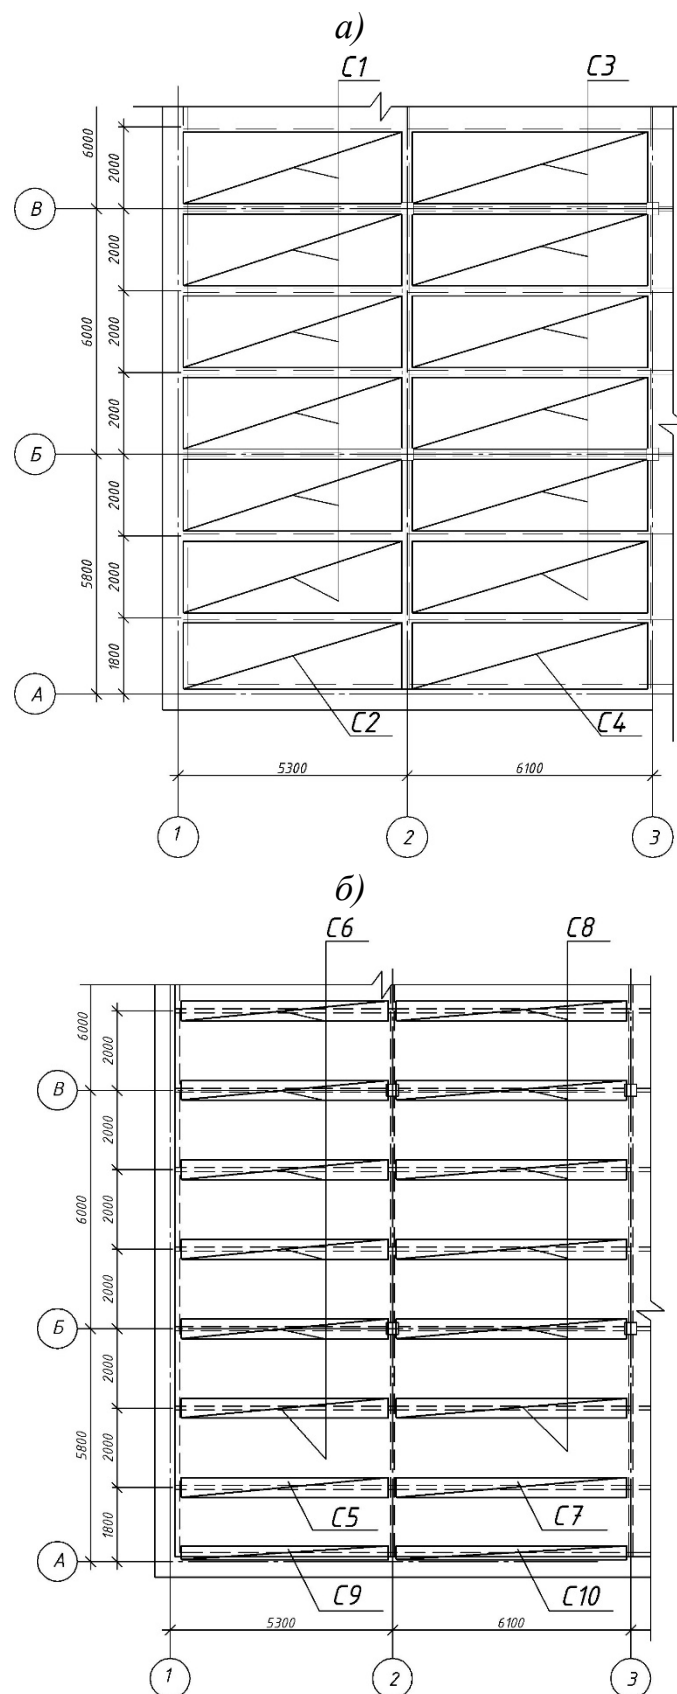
Армування плити зварювальними сітками з поперечною робочою арматурою:
